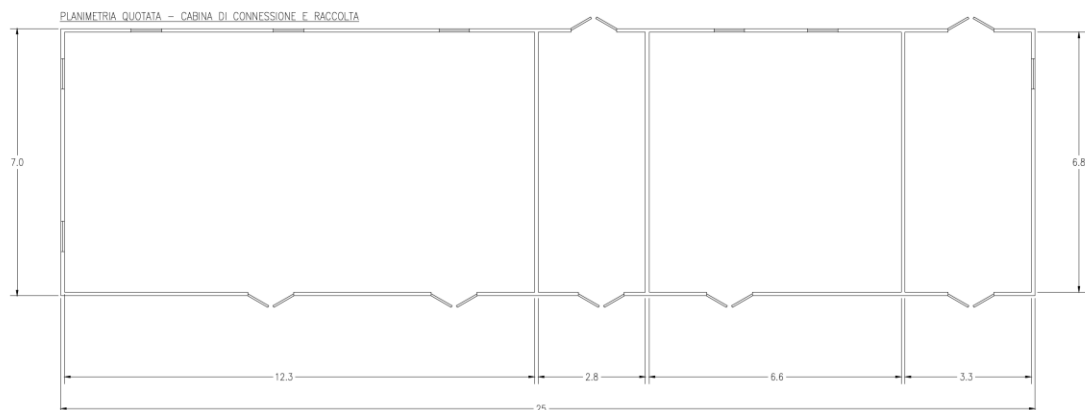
VISTE IN PIANTA E PROSPETTO CABINE DI RACCOLTA
